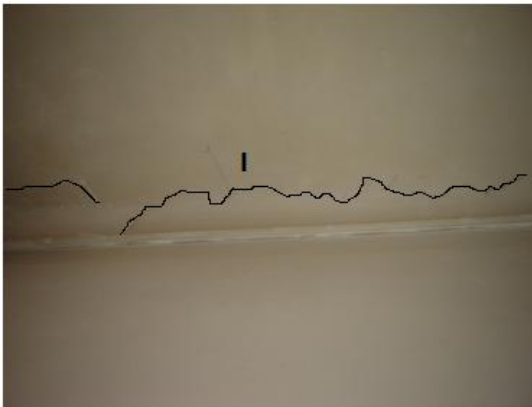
Fissura no bordo da parede e tecto "l"
